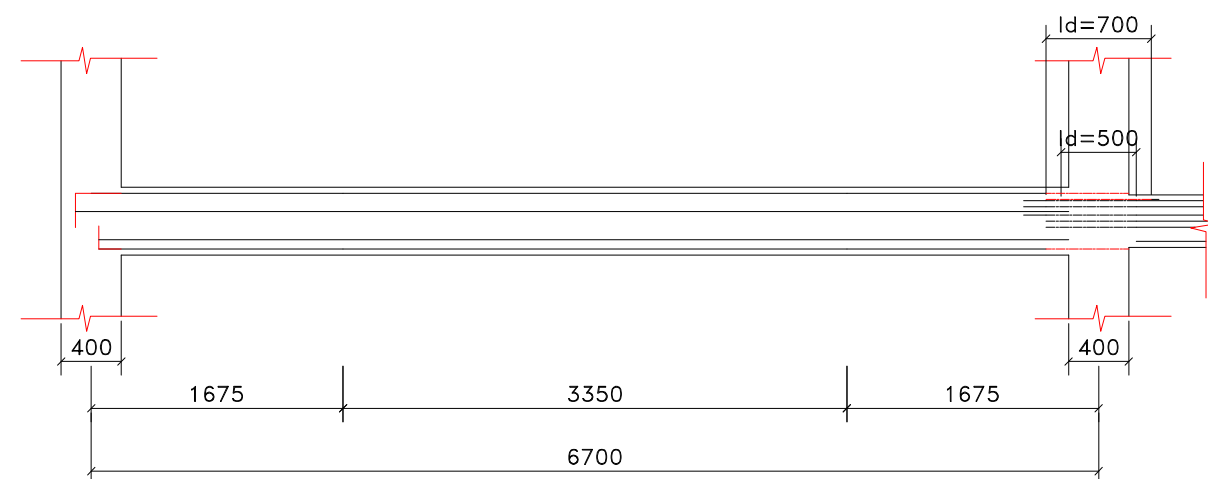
DETAIL PENULANGAN BALOK LANTAI 1 As A-B
